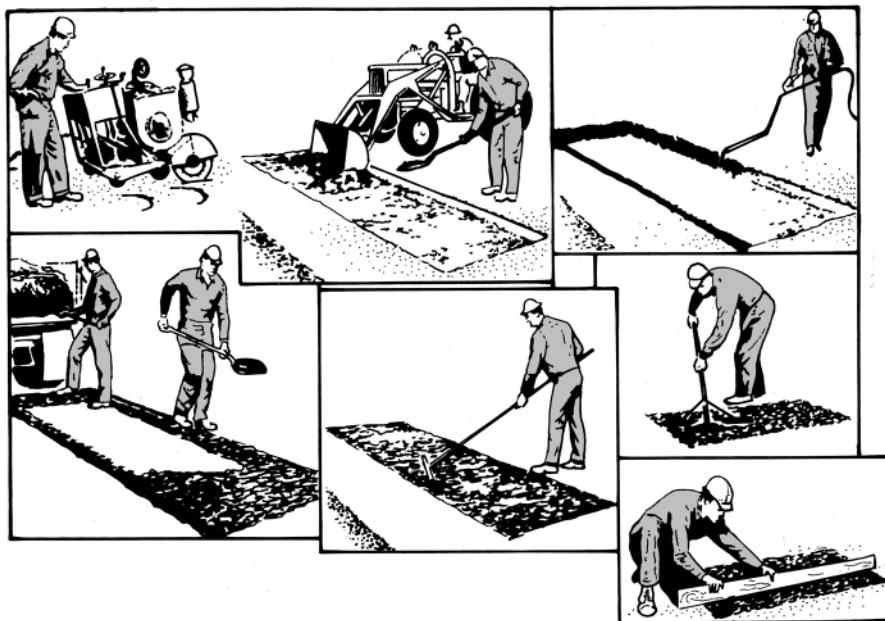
Hormigón asfáltico en frío para bacheo.
